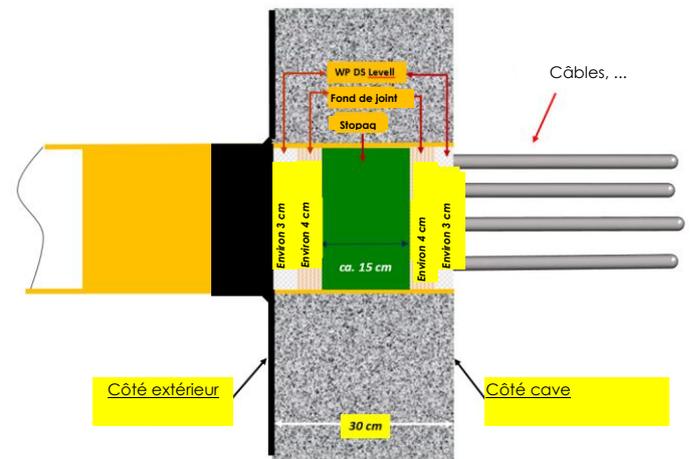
détail de l'étanchéité à l'eau de la traversée de tuyau - étanchéité dans le tuyau
